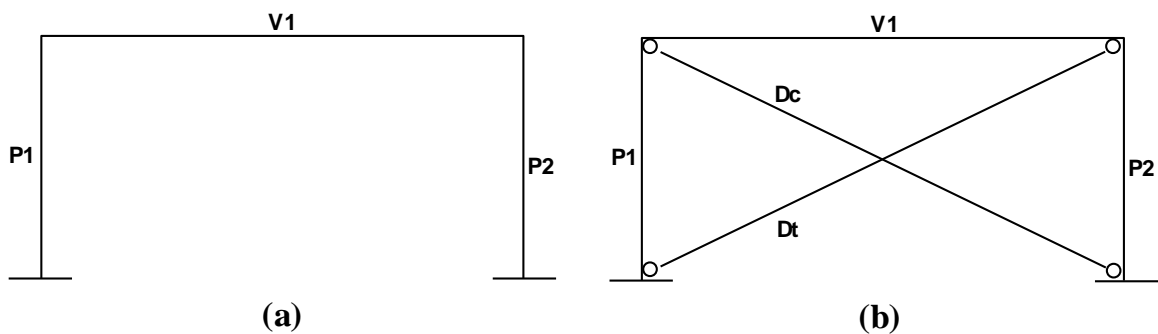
Pórticos de 1 Piso: (a) não-contraventado (b) contraventado.
